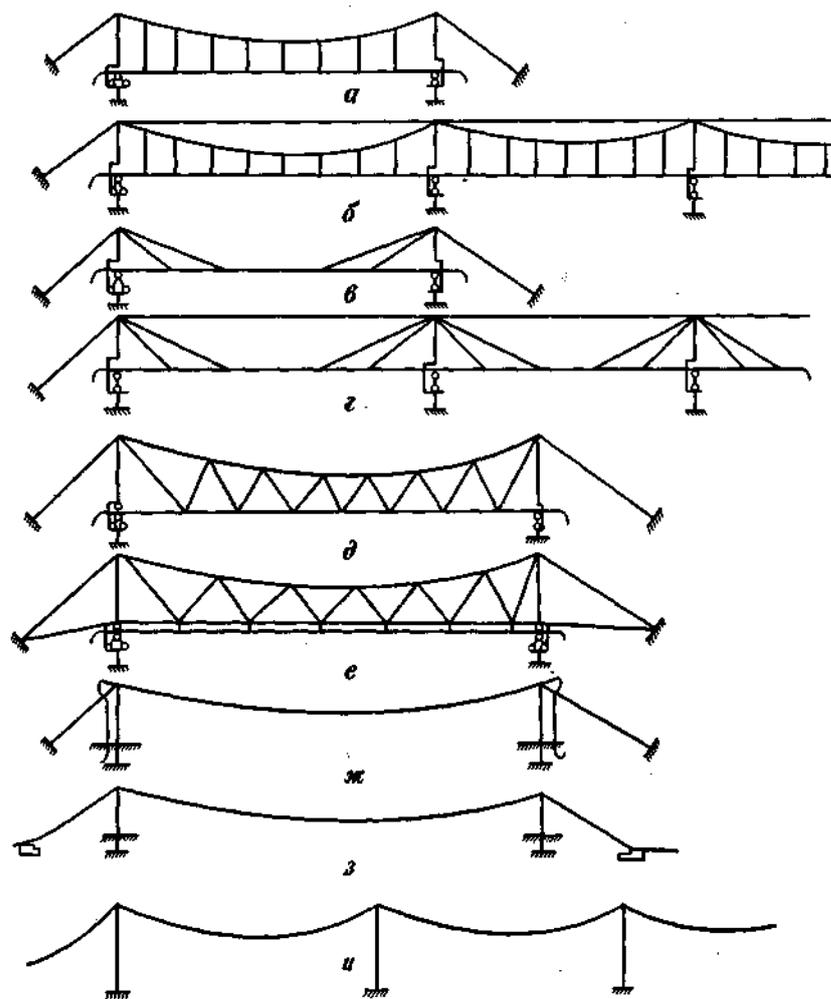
Схемы висячих переходов: а, б – переходы с одноцепными висячими фермами; в, г – с Байтовыми фермами радиальной системы; д, е – с Байтовыми фермами и треугольной решеткой; ж – и – переходы в виде провисящей нити [31]
